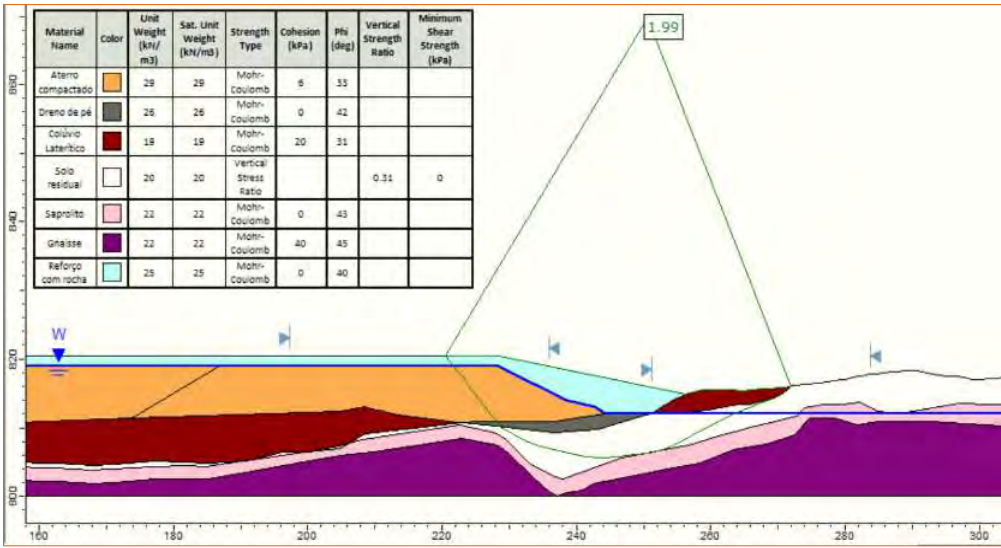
Seção A-A - Condição Não Drenada - Superfície não circular - FS = 1,99.
